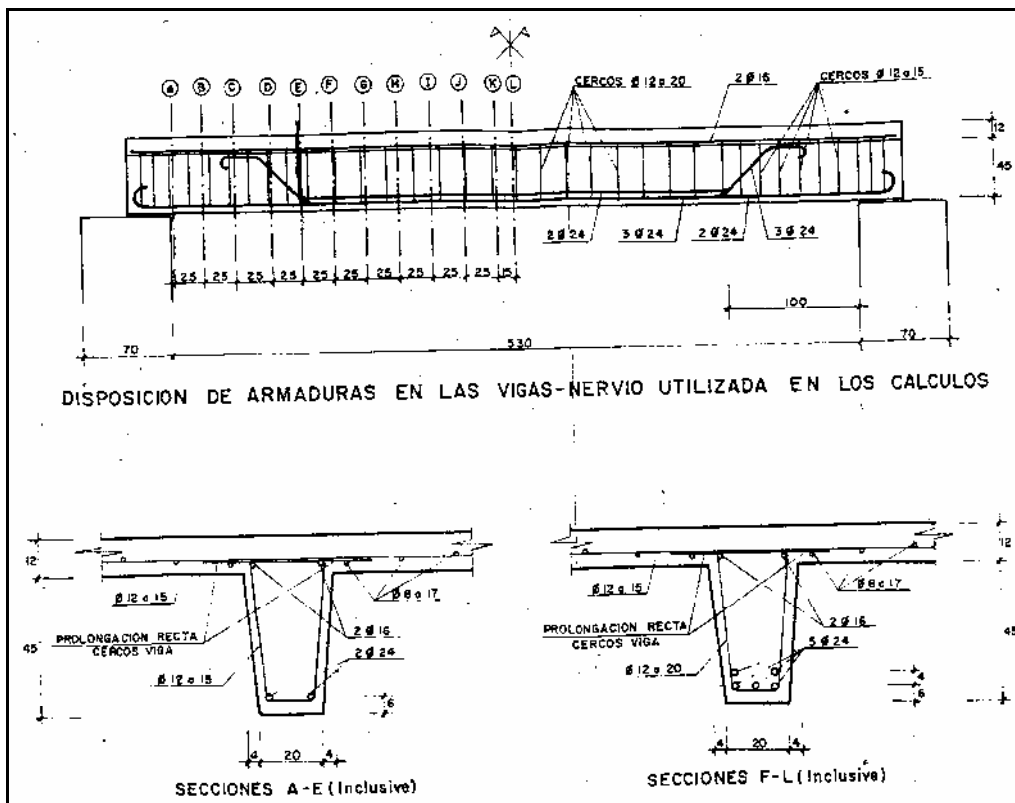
Plano conservado de definición de la losa nervada existente (1983)
